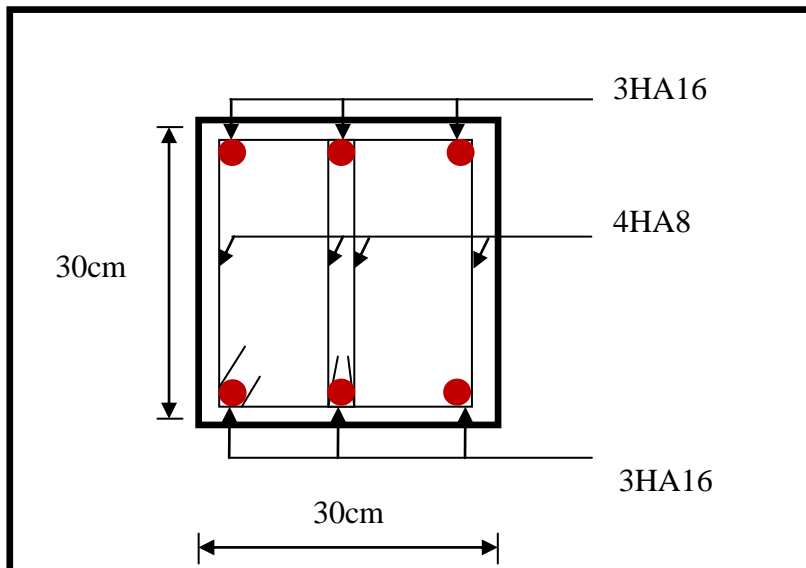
Ferrailage en travée d'une poutre secondaire.
